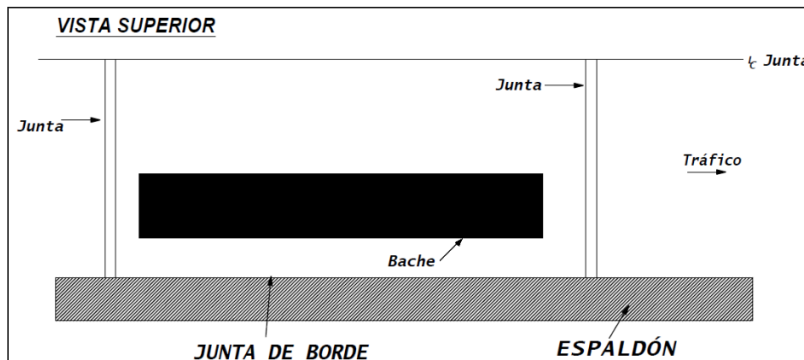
Esquema Baches mayores a 0,5 m² - Pavimento Rígido Continuo
